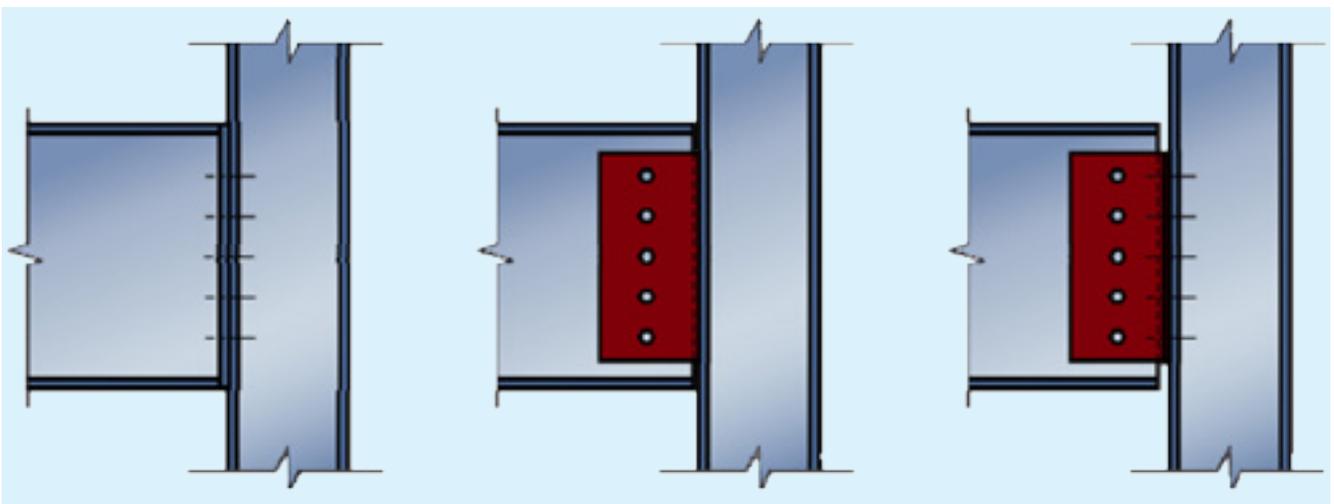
Шарнирные узлы: а) фланцевое, б) сварное, в) болтовое соединение на двойных уголках
